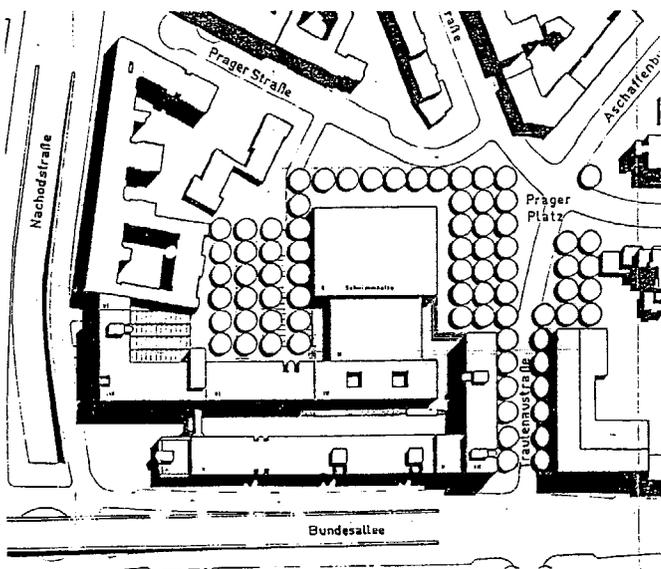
Die Bebauung zwischen Bundesallee und Prager Platz mit Ladenpassage Hallenbad im Entwurf der Gruppe 67.
